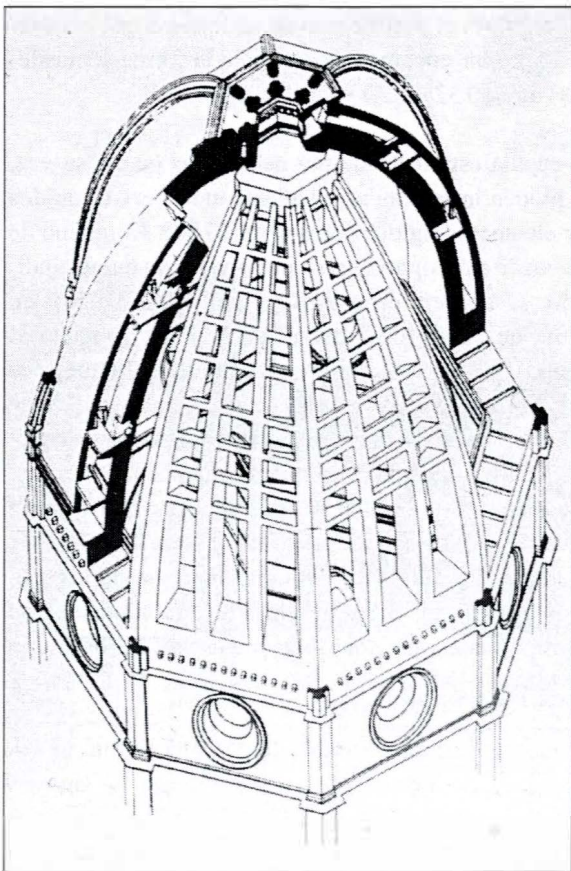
Axonometría del esquema constructivo de Santa María de la Flor
